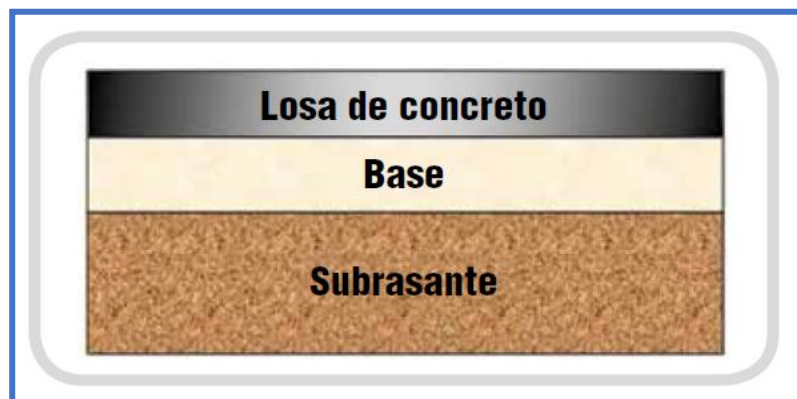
Sección transversal convencional de un Pavimento Rígido.
